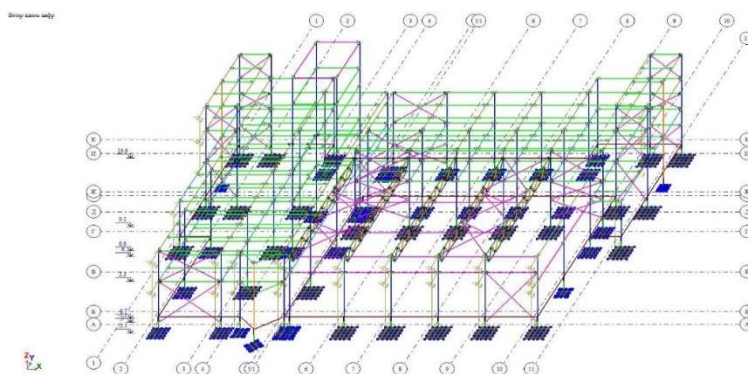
Нагрузки. 5 – Ветер вдоль цифровых осей
